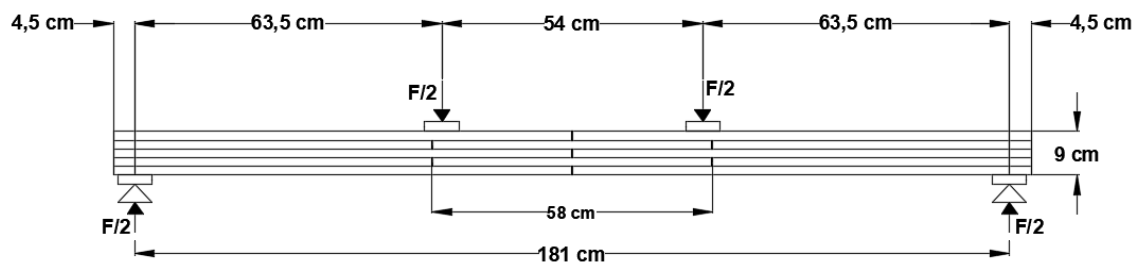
Disposición de cargas y apoyos en vigas con láminas empalmadas.
